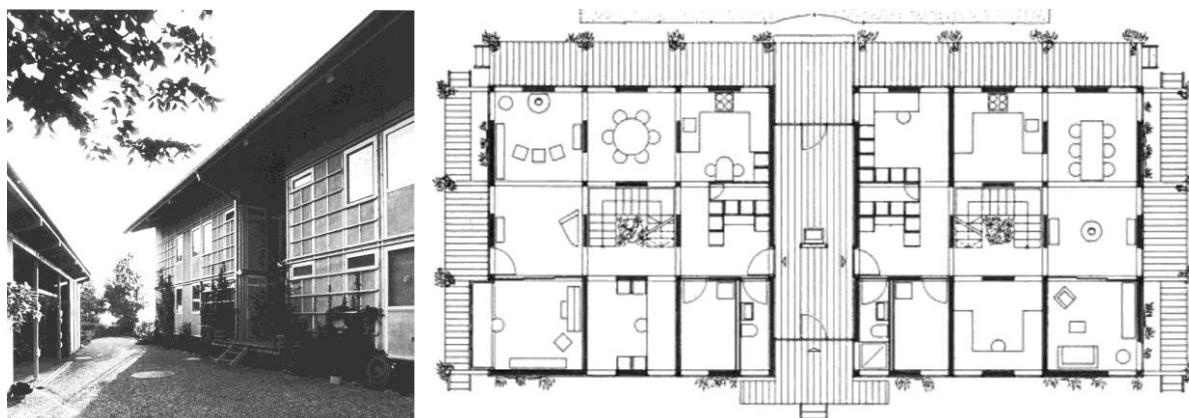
maison double à Mühleturnen, photo de l'entrée et plan du rez-de-chaussée / Bauart Architekten und Planer AG
